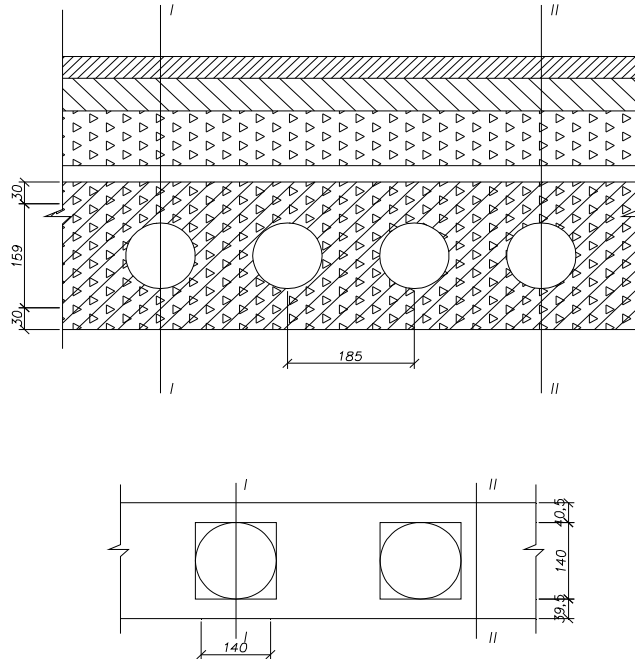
Розрахункова схема до розрахунку опору теплопередачі перекриття.
